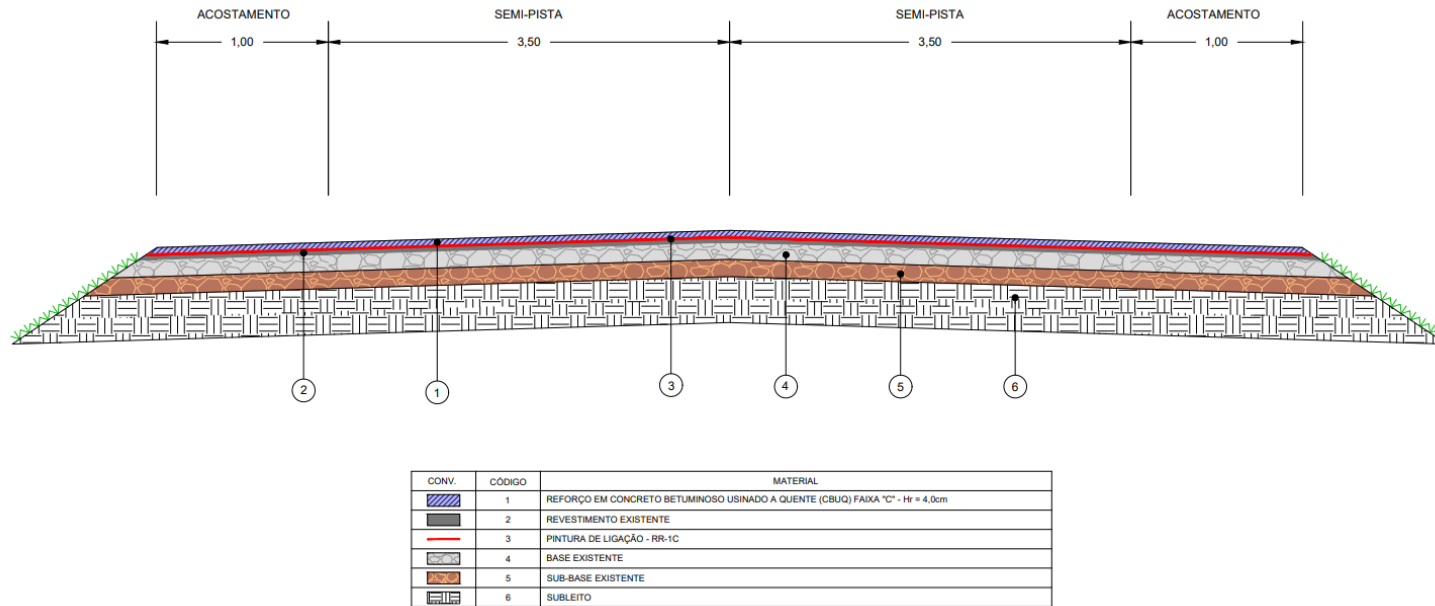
Seção Típica Projetada (Reforço do Pavimento)
